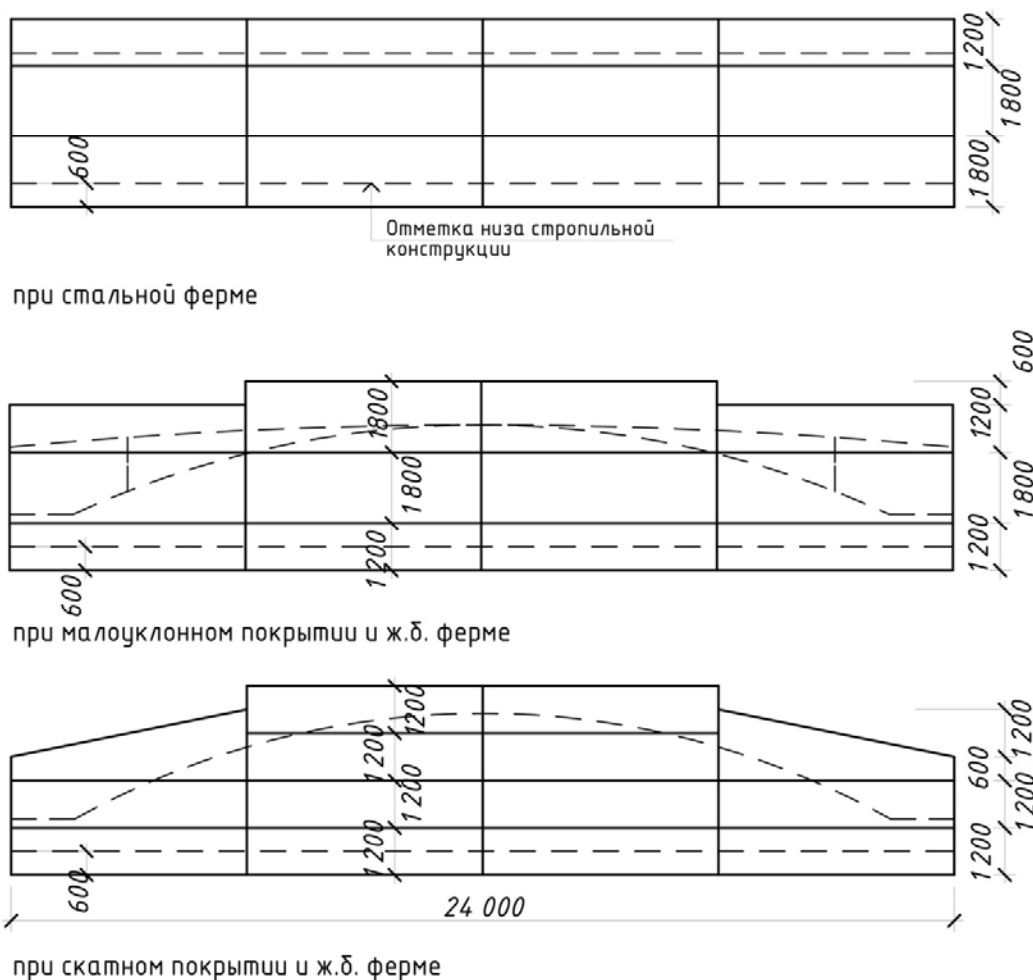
Примеры раскладки панелей торцевых стен в зоне конструкции покрытия.
